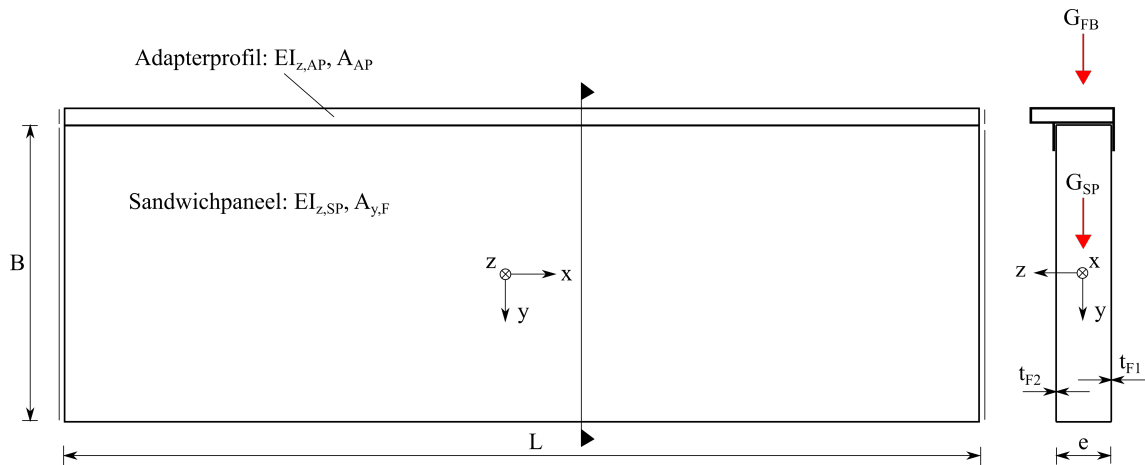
Statisches System Sandwichpaneel-Adapterprofil bei Belastung in Fassadenebene
